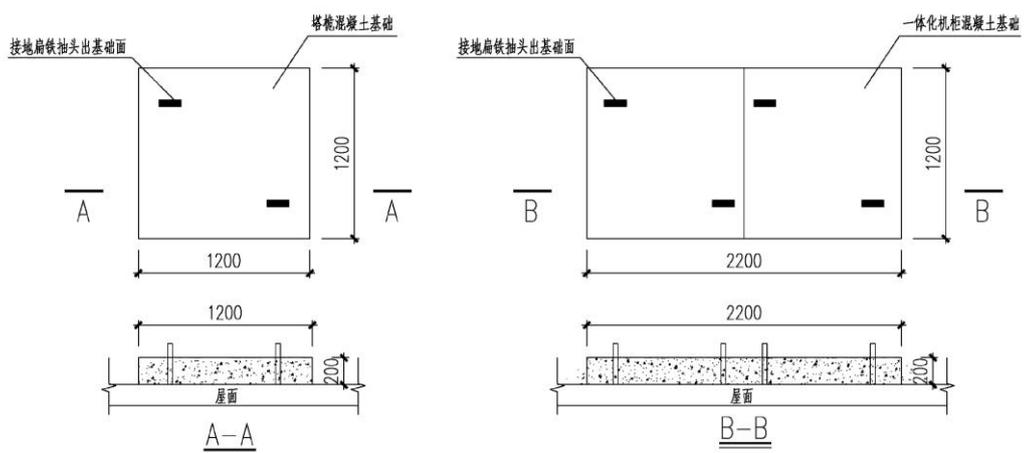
平屋面屋面设施（预留混凝土基础建设方式）大样图
